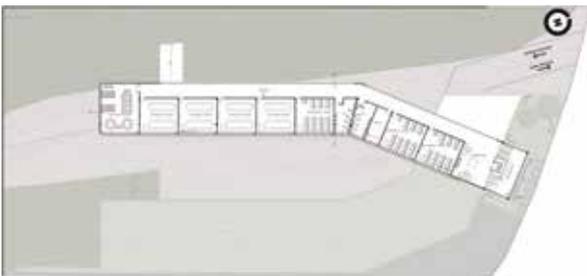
Planta baixa do 2º pavimento – Bloco A
